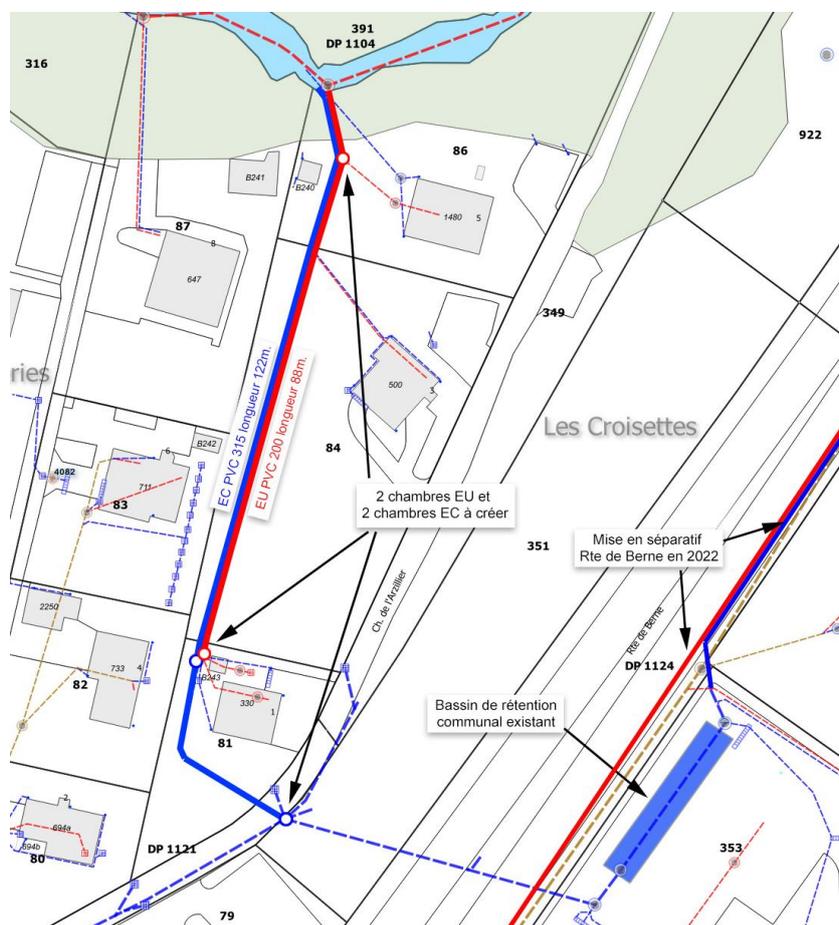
Plan des travaux sur le chemin de l'Arzillier
